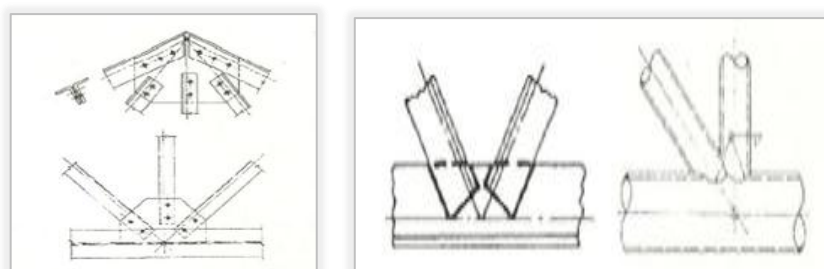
Ligação em treliça, aparafusadas e soldadas.
